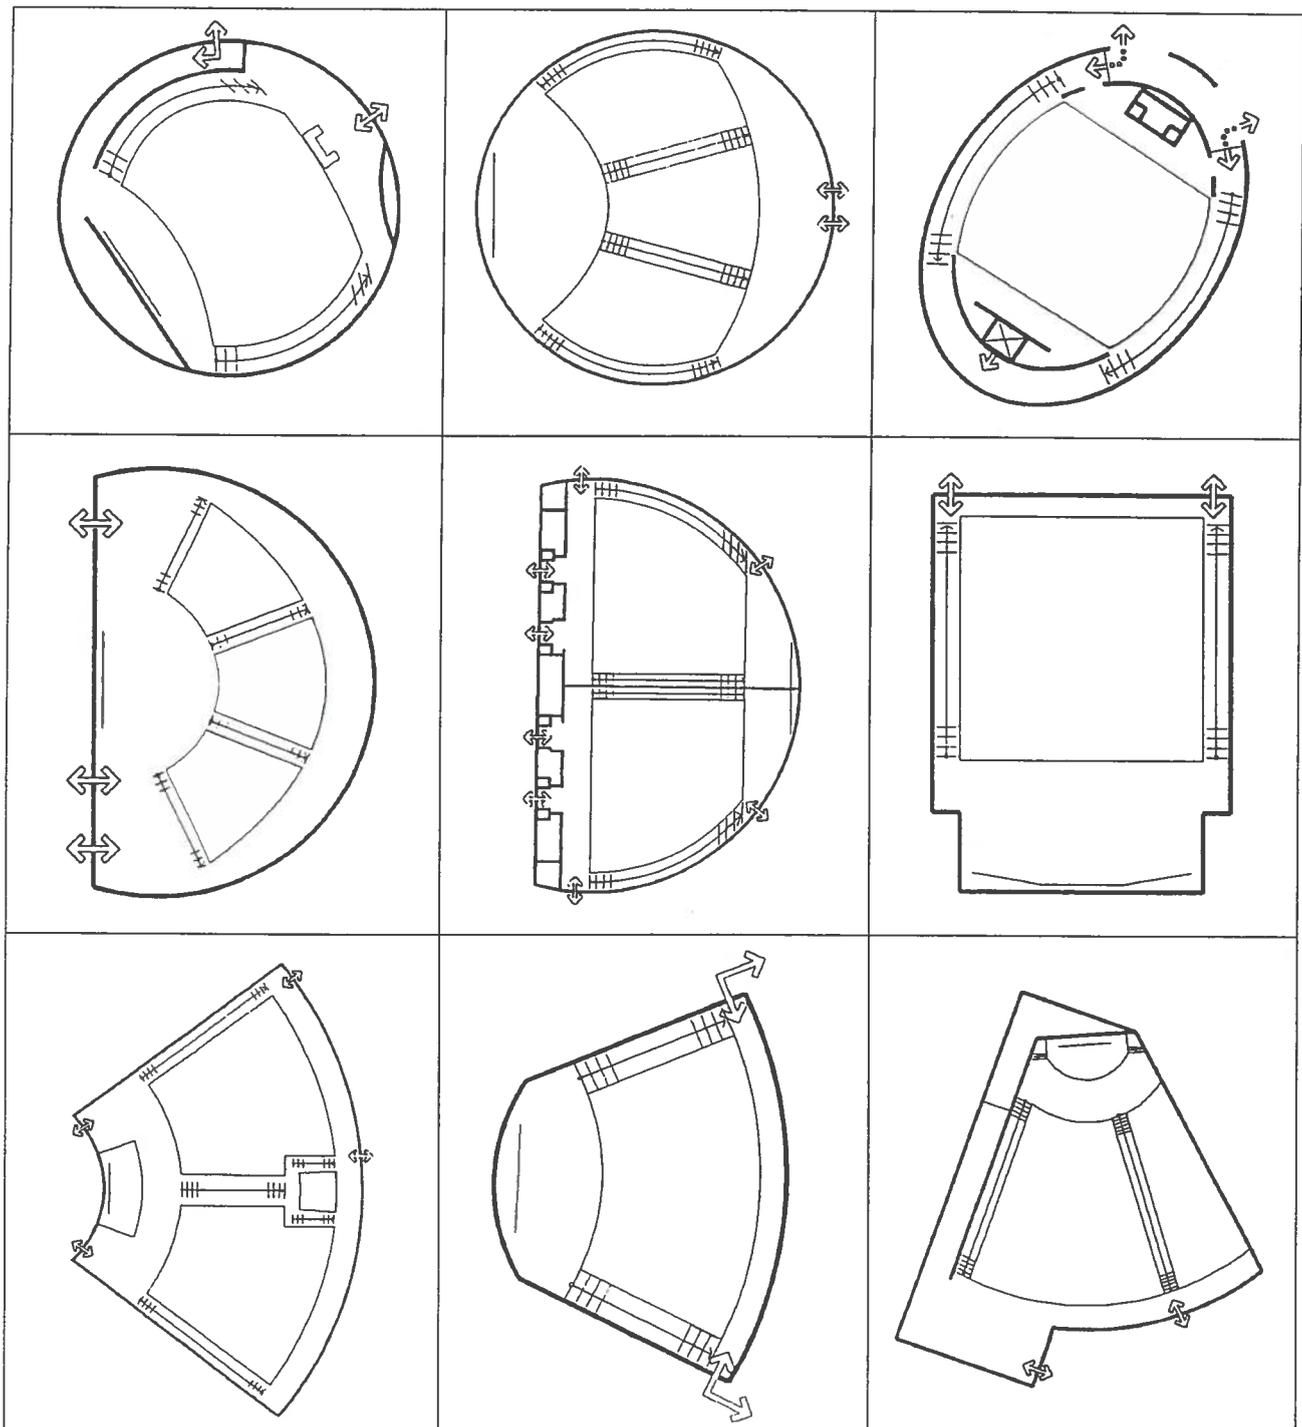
Übersicht über realisierte Grundrißformen von Hörsälen anhand von Schemagrundrissen
